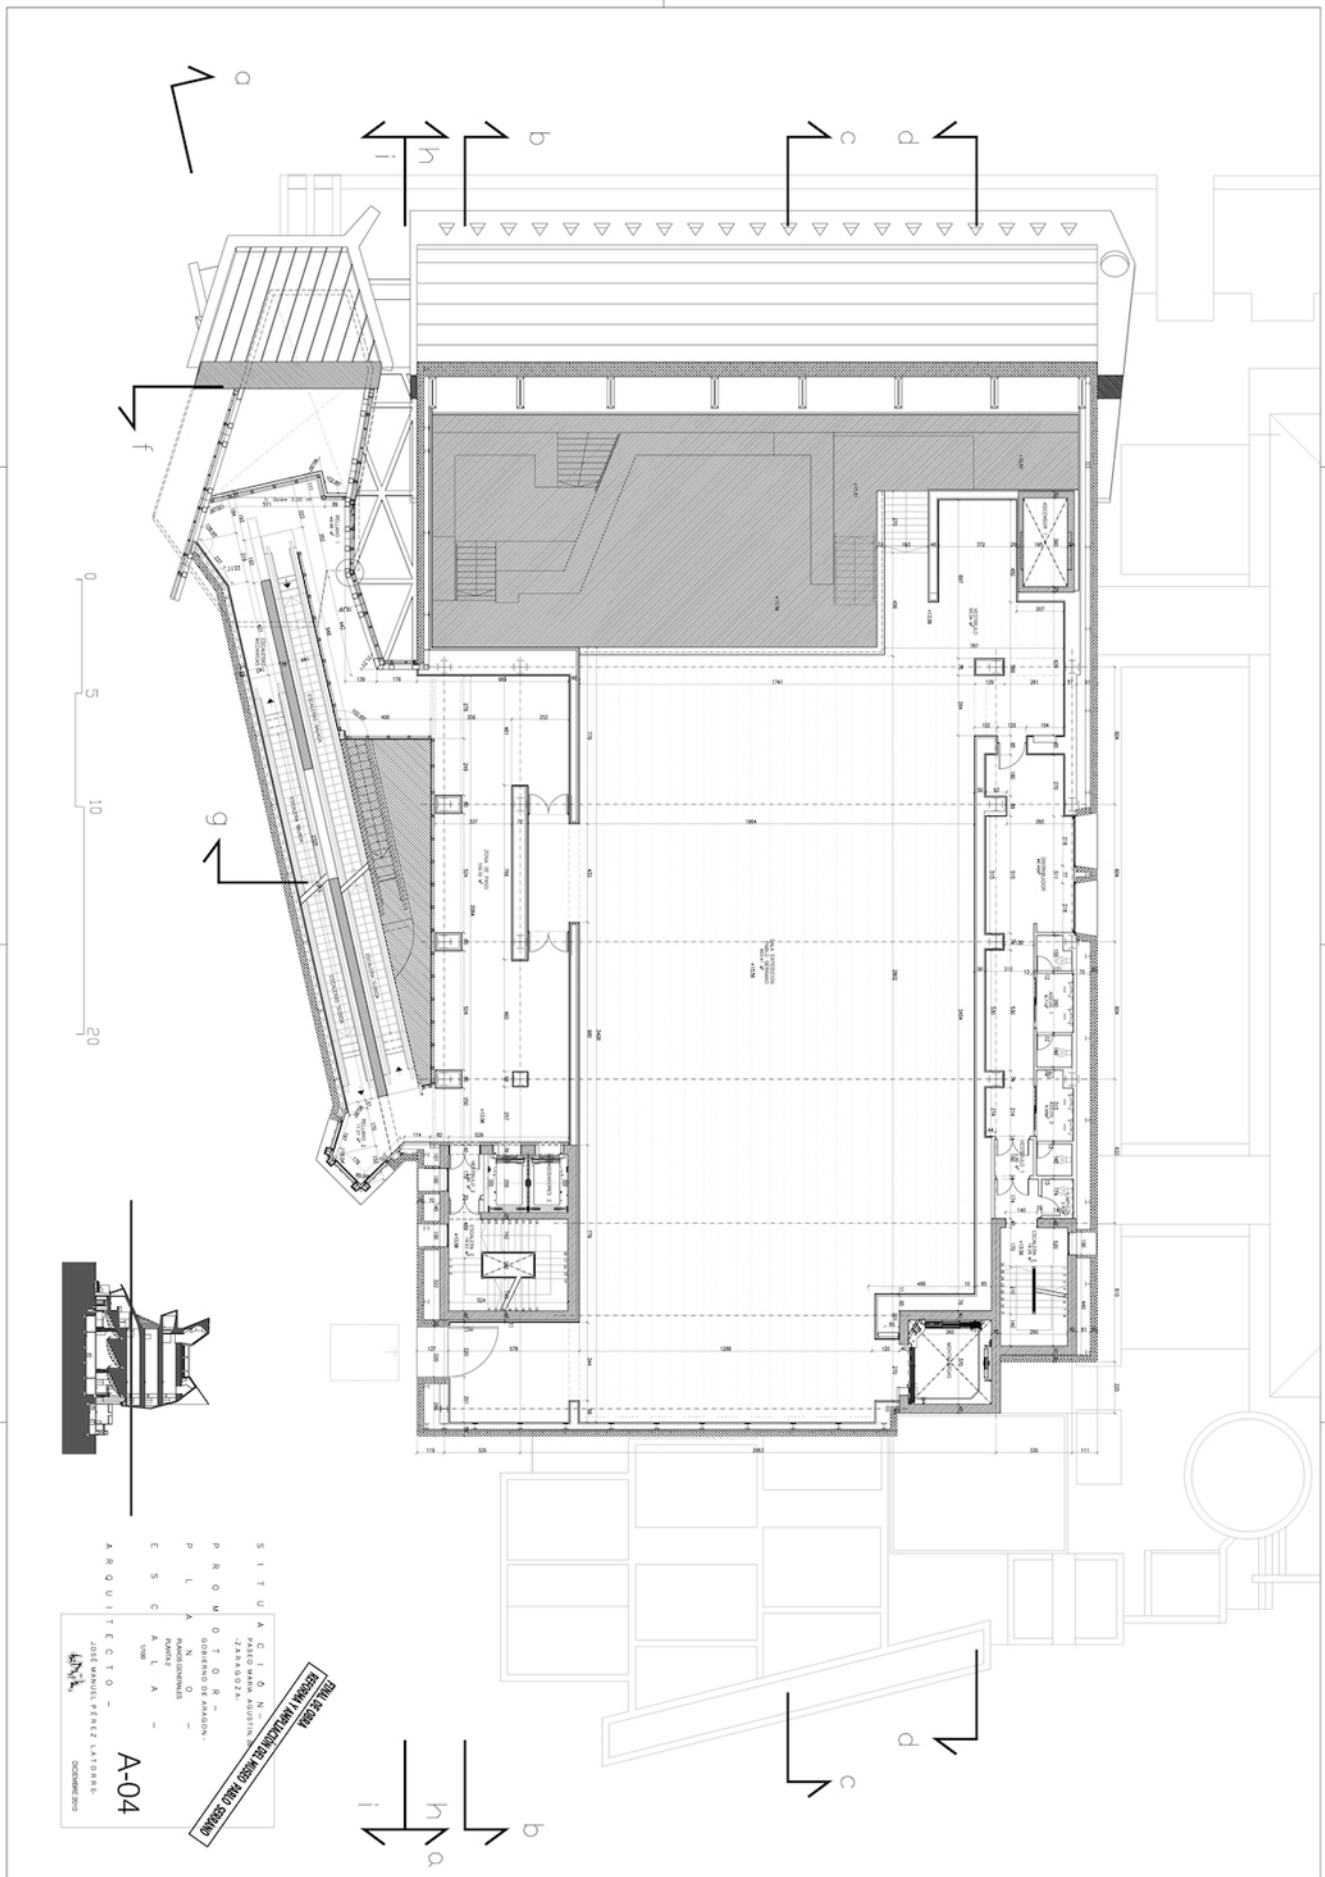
Planta segunda (según J.M. Pérez Latorre)
